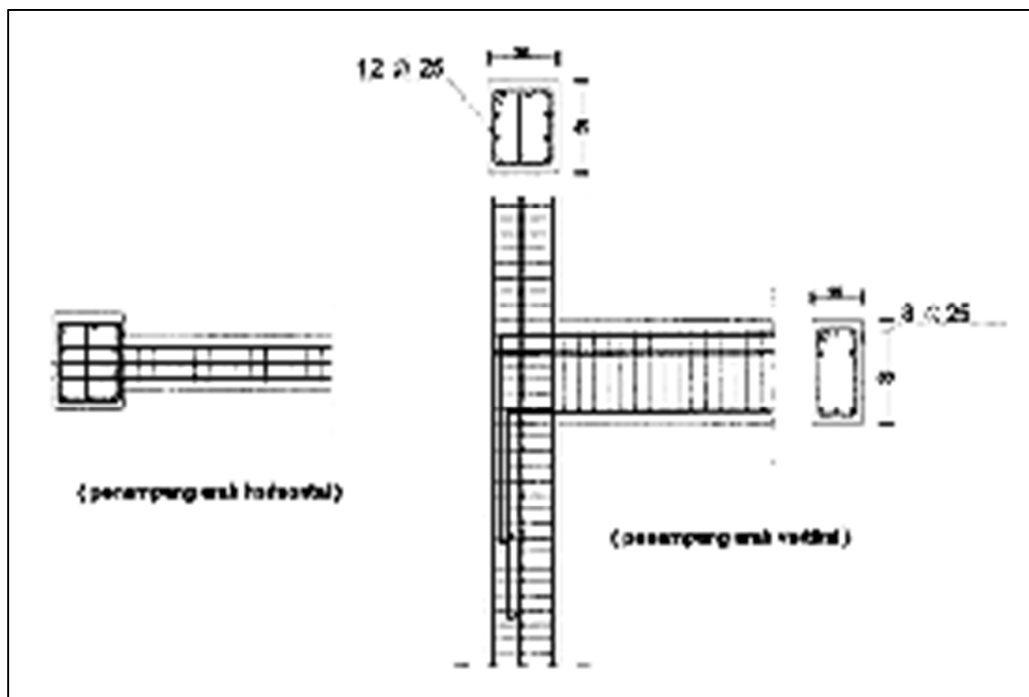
, Detail Hubungan Balok Anak dan Balok Induk arah Horizontal
